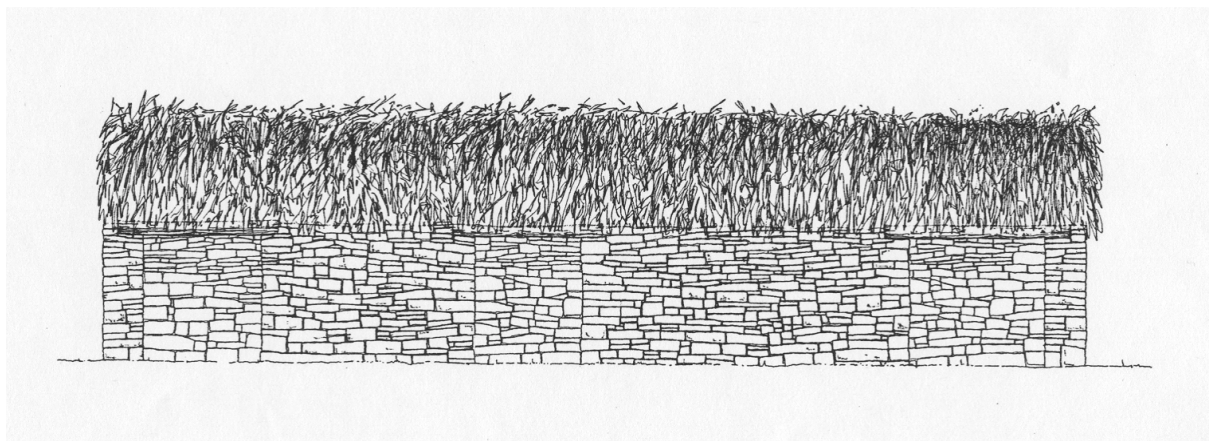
El Ceremeño, Herrería (Guadalajara). Propuesta de alzado principal
